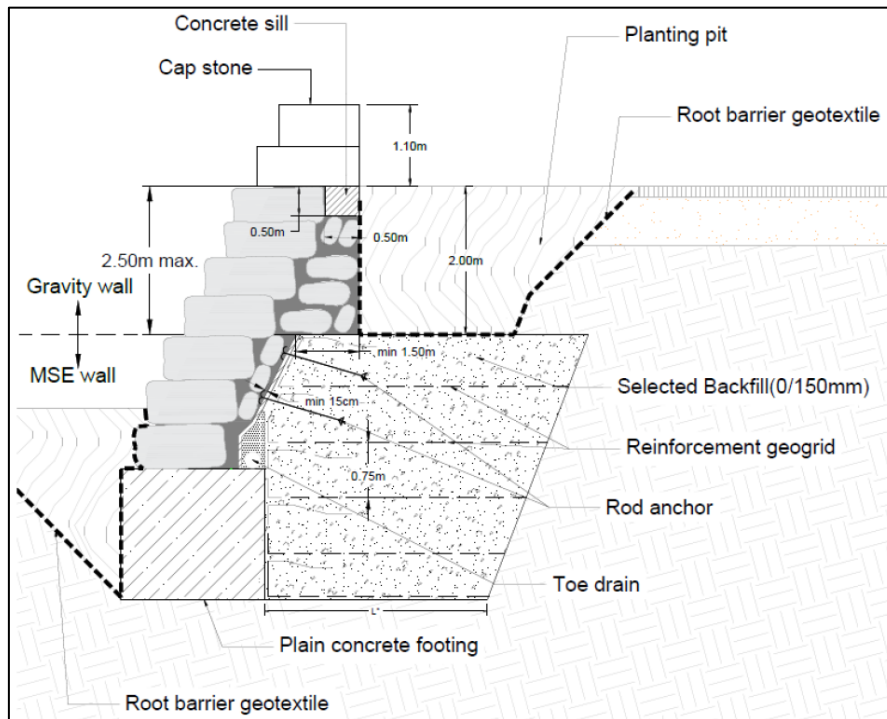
Coupe type d'un mur composite : sol renforcé (MSE Wall) et mur poids (Gravity Wall)
